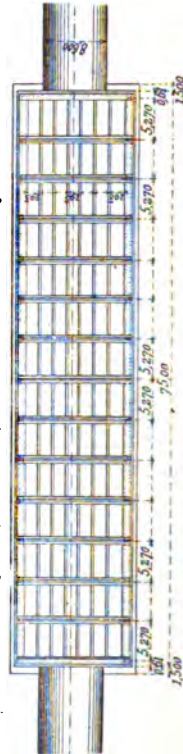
(Ech. 1/1000). — Coupe horizontale au-dessous du tablier.
